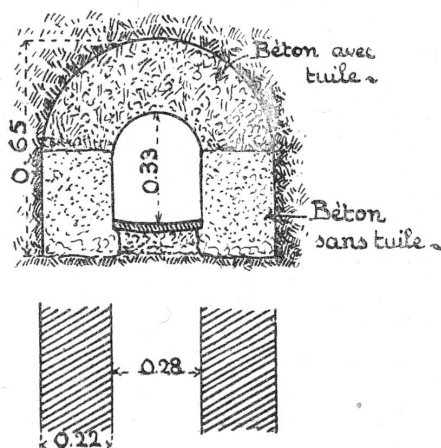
Plan et coupe de l'aqueduc de Versoix.
